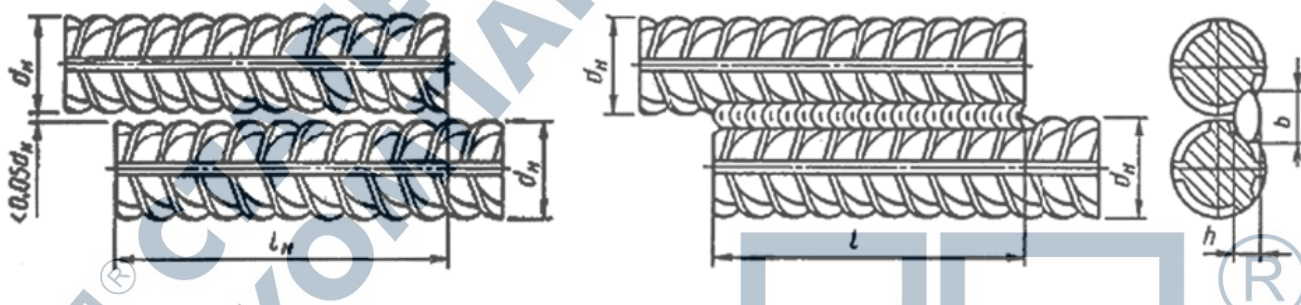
Соединение арматурных стержней ручной дуговой сваркой
